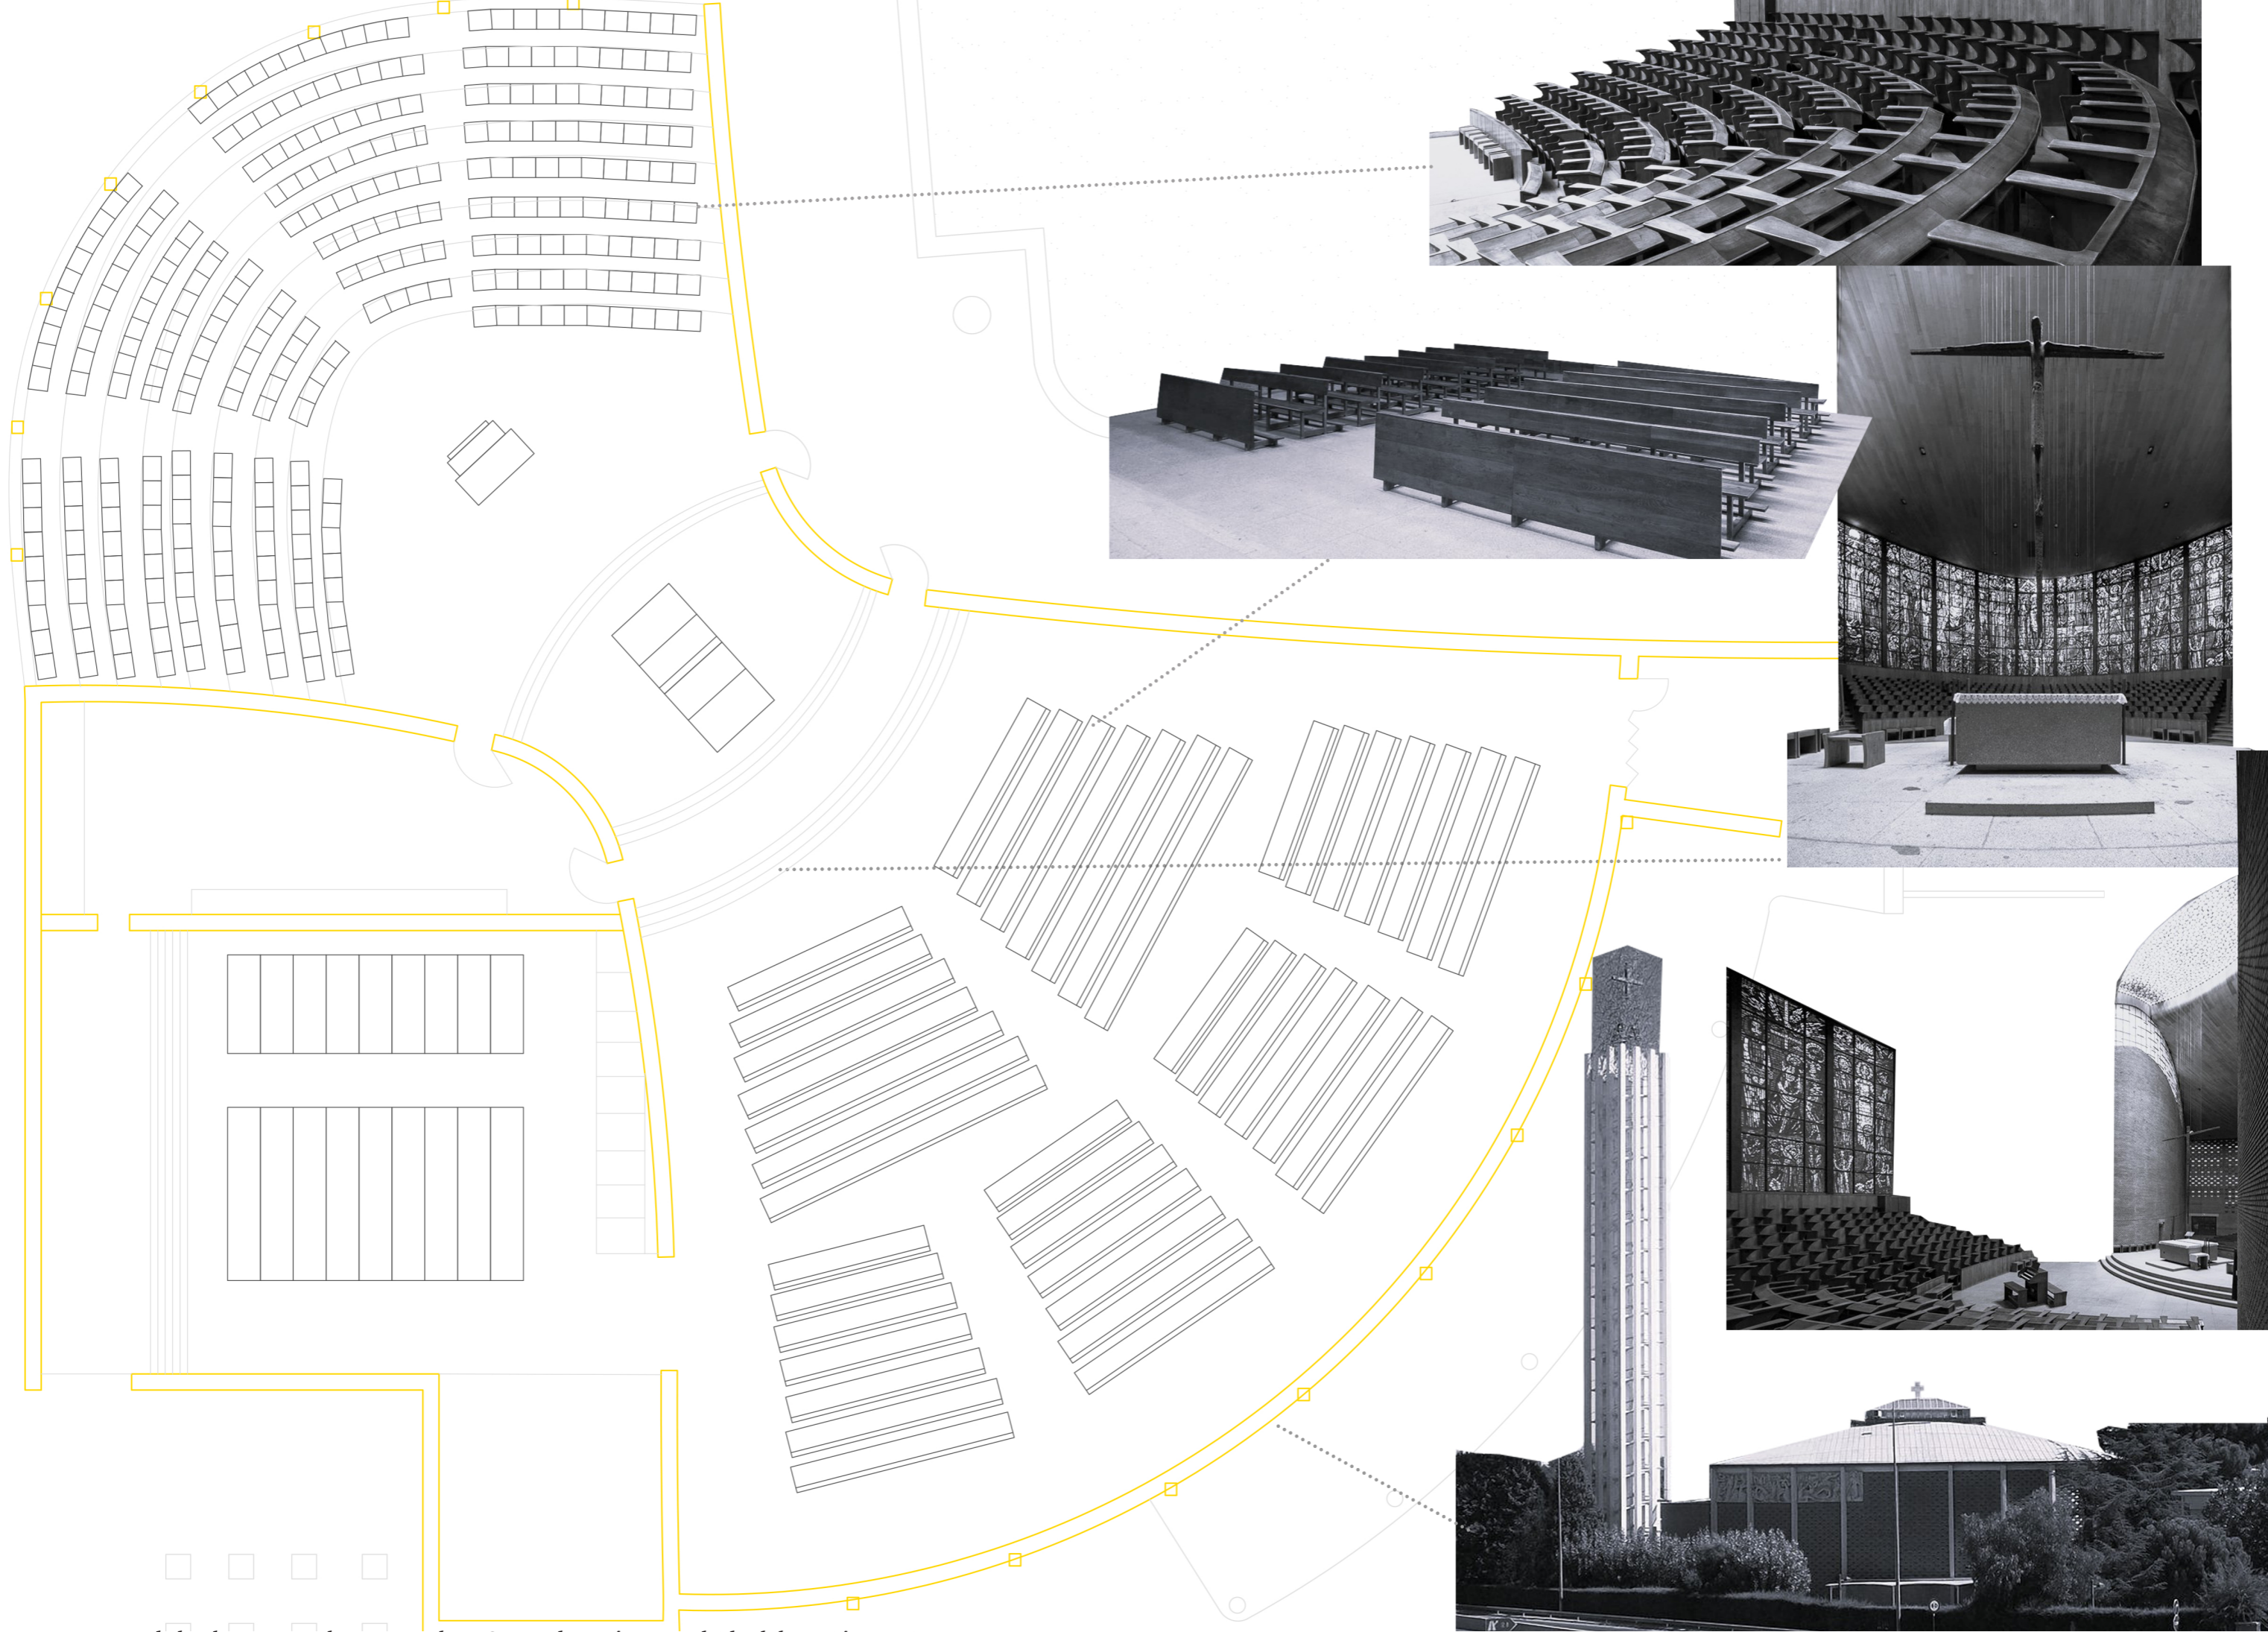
Fotomontaje de la planta y sus elementos, Iglesia San Pedro Mártir, Madrid, Elaboración propia
